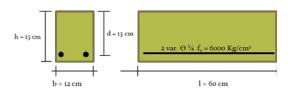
Dimensionamiento de vigas de concreto simplemente reforzadas
